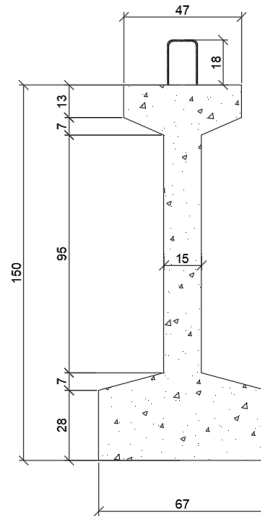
Sección transversal de vigas principales pretensadas
